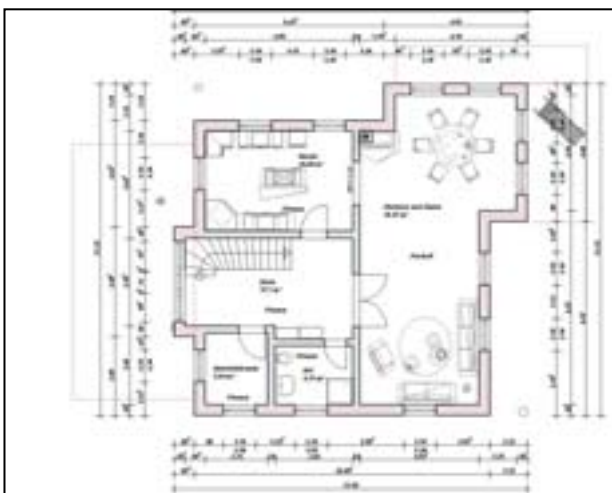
Grundriss Erdgeschoss eines geplanten Einfamilienhauses
